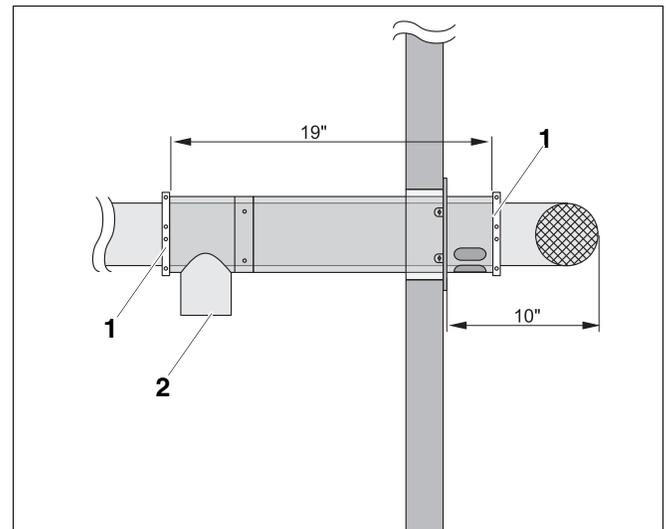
Position du raccord en T de la conduite d'évacuation des fumées
